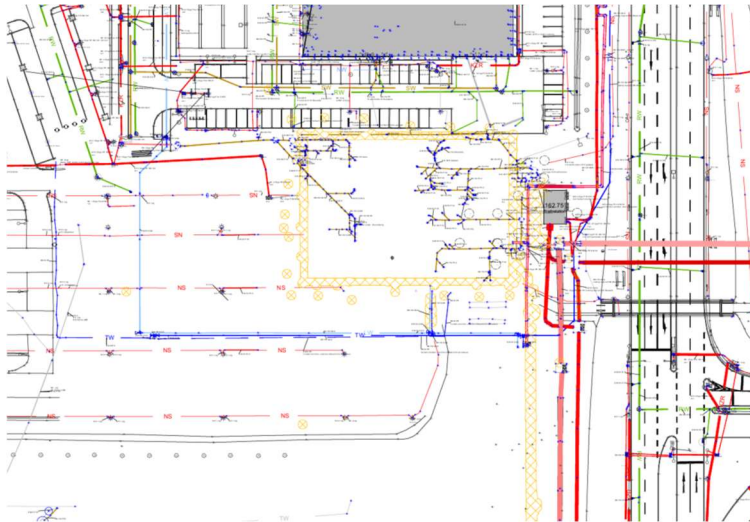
Spartenplan im Bereich der Baustellen- und BE-Fläche
